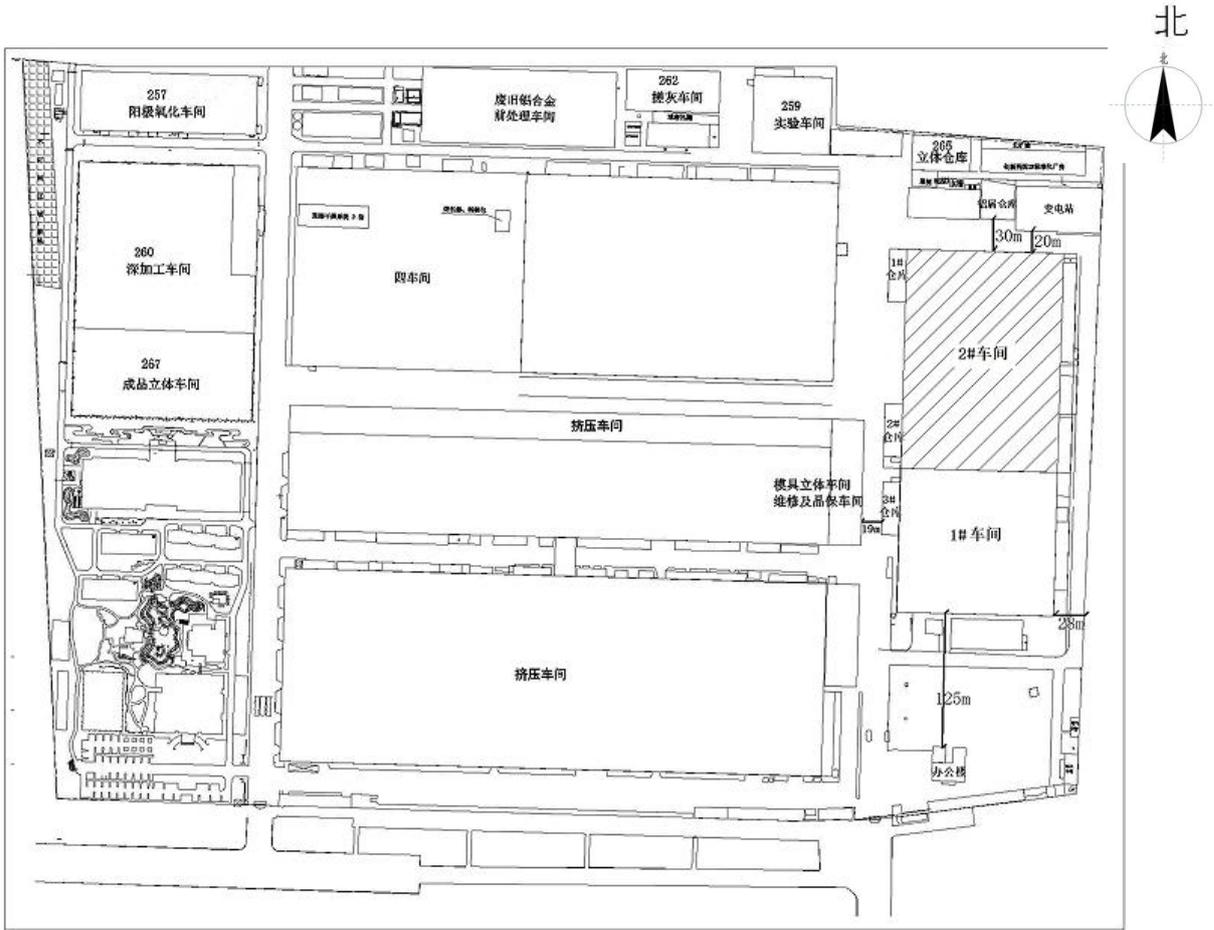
总平面布置图 ( 为该项目所在位置)
